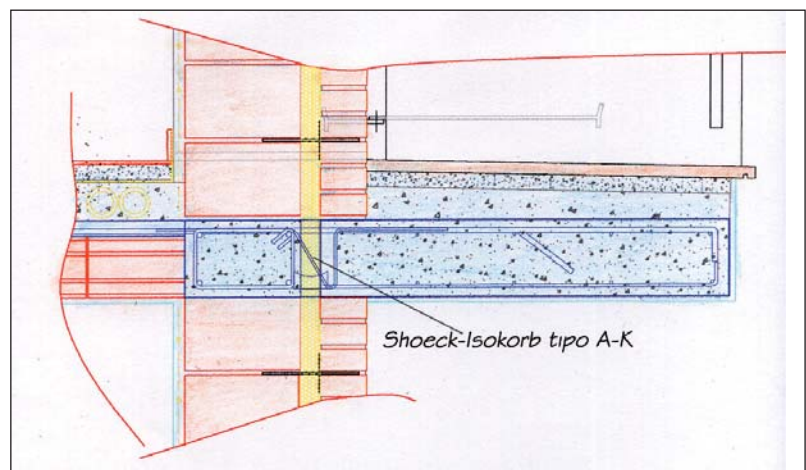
Correzione ponte termico balcone con sistema brevettato e certificato (Isokorb A.K. Schoeck).
